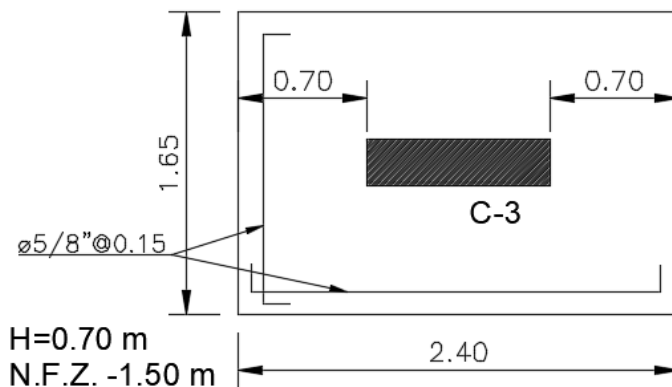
Armadura final de zapata aislada correspondiente a la columna C-3
